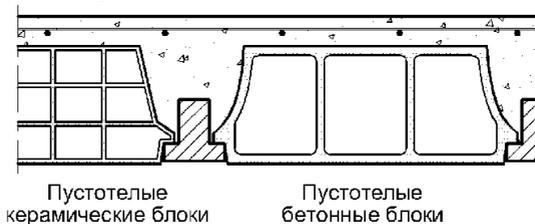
Конструктивное решение плиты перекрытия с высокопрочными пустотелыми блоками
